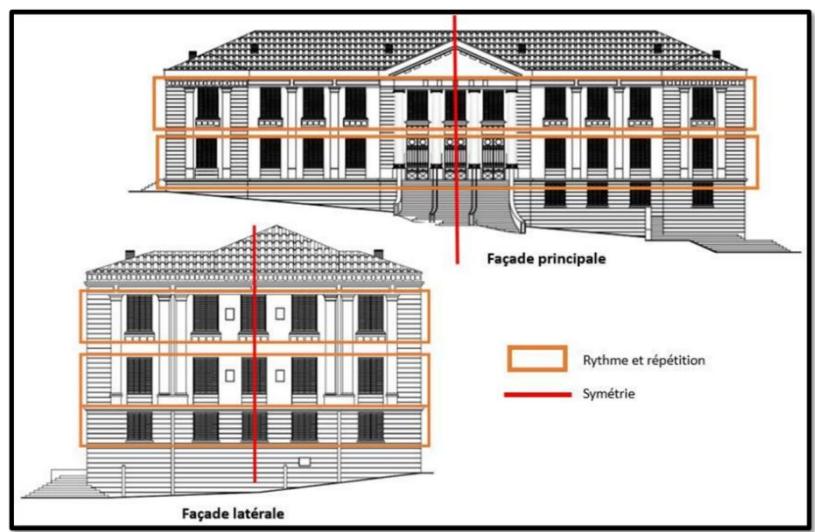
Lecture des façades (Fond : façade de la direction de l'urbanisme. Traitement : auteur 2025.).
